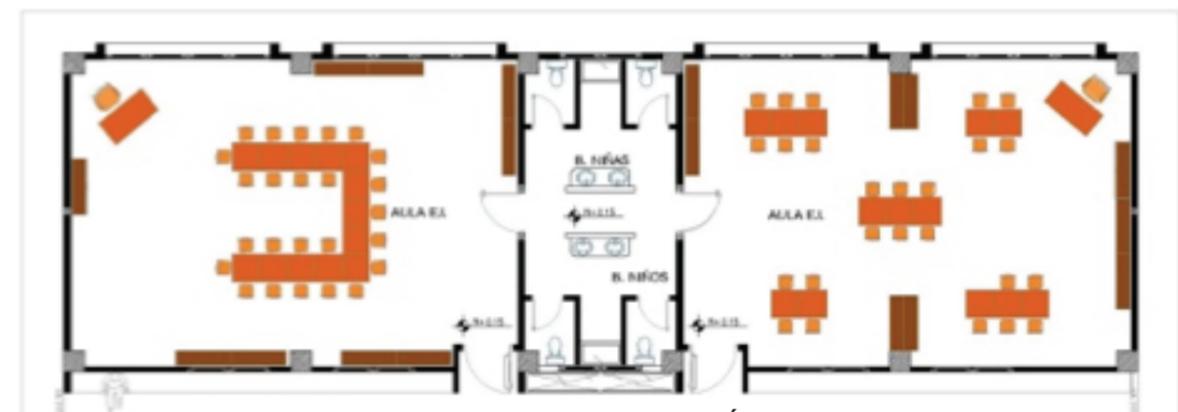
Planta tipo. Fuente: Ministerio de Educación, 2009
